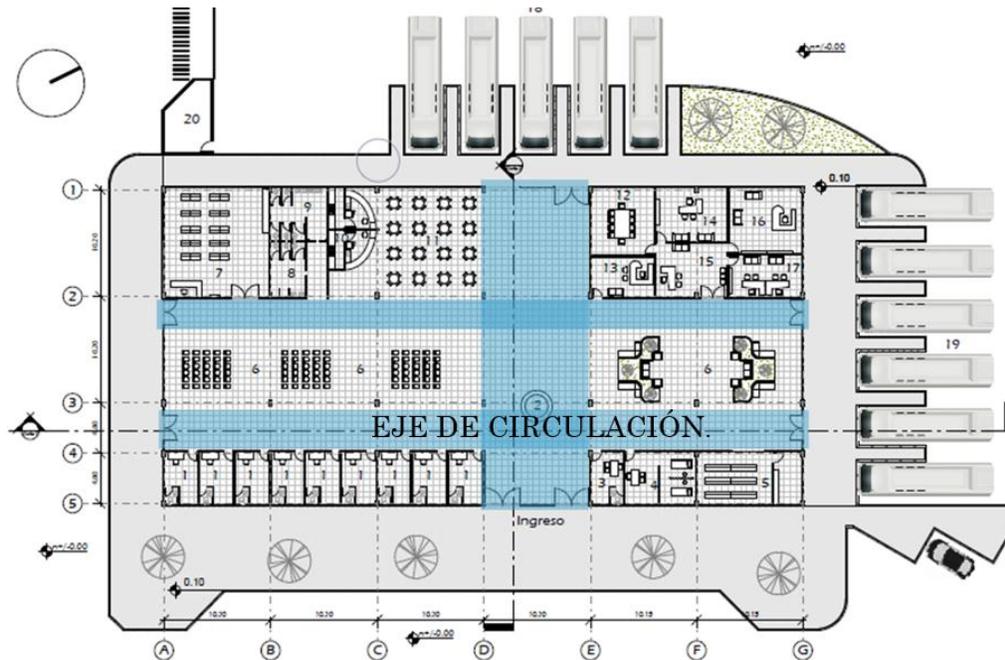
Planta Arquitectónica de Administración, cafetería, Servicios Generales.
